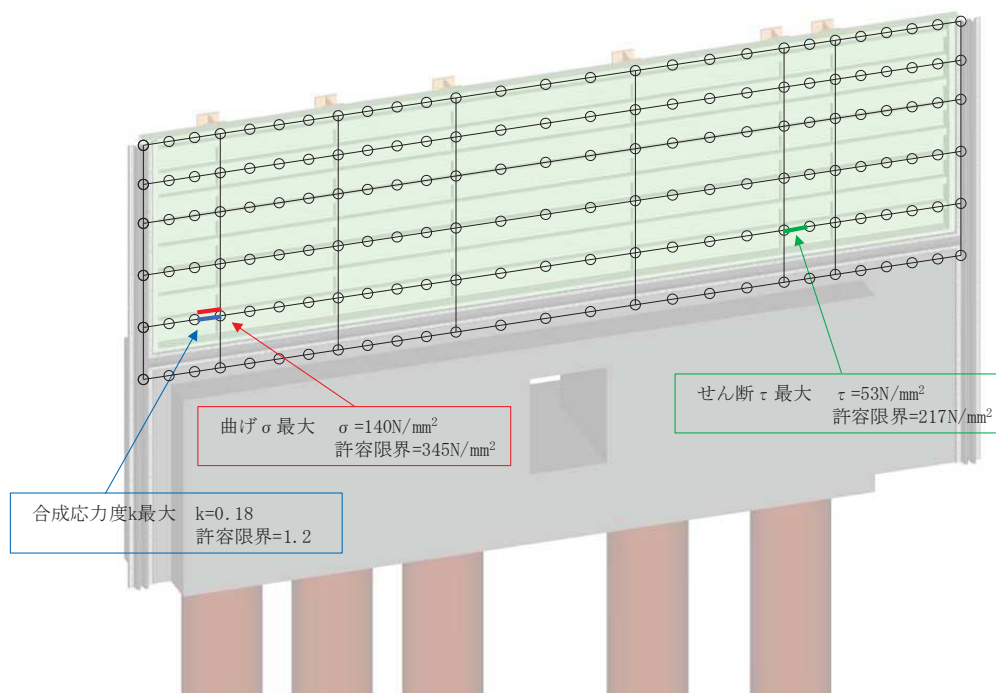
鋼板の曲げ・軸力系の破壊及びせん断破壊に対する
